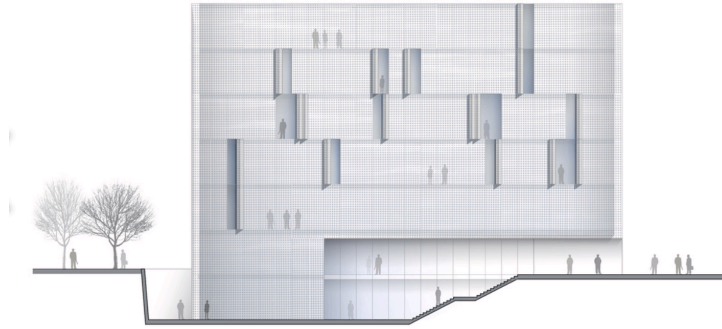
Fachada del edificio, vista de paneles metálicos. (ArchDaily, 2011)
